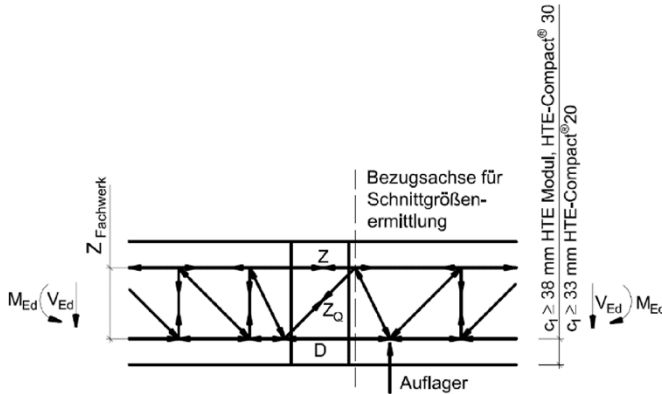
Schöck Isokorb® Typ K, K-F (Variante mehrteilig) mit Druckelementen aus Beton
